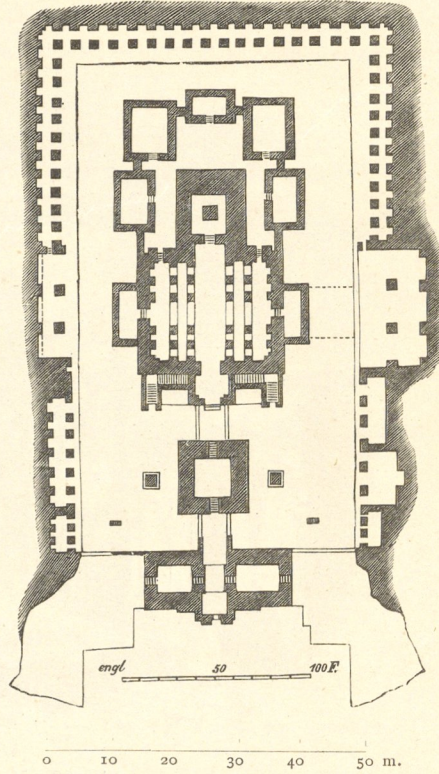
Kailasa zu Ellora. Grundriss.
